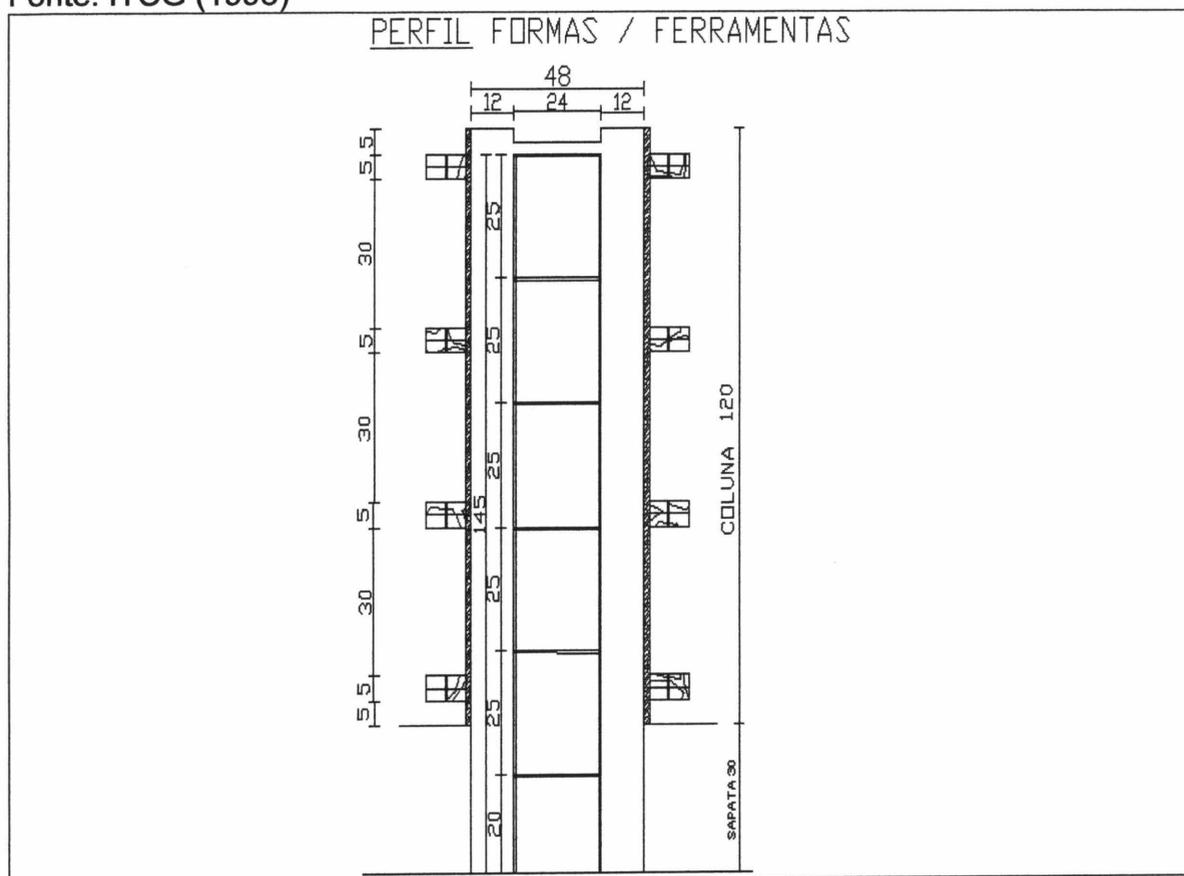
Esquema do pilar com dispositivo centragem forçada.
